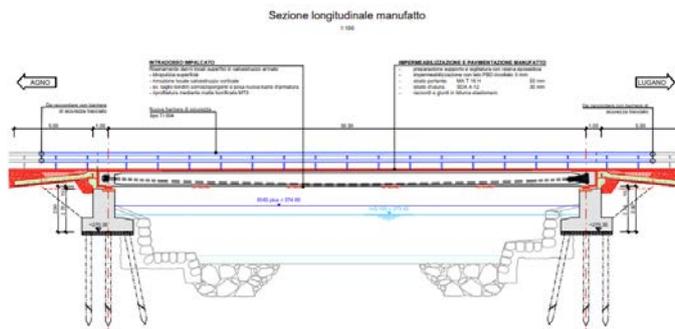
Vista longitudinale stato attuale e progetto Ponte sul Vedeggio
